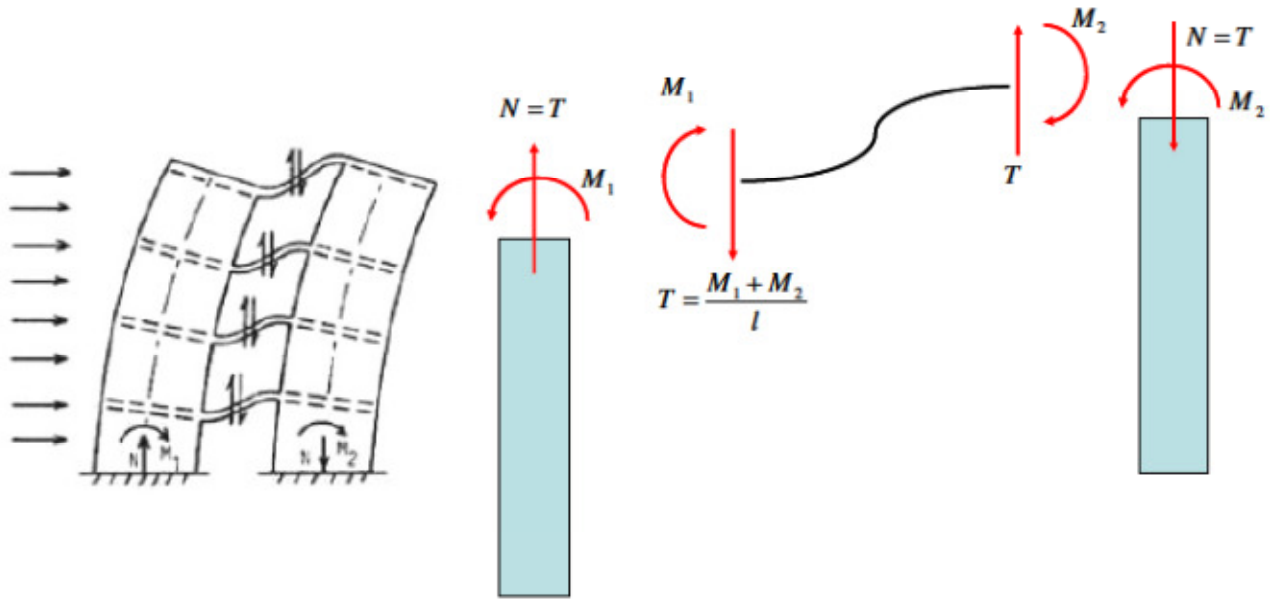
Sollecitazioni sulle membrature di collegamento di piano
